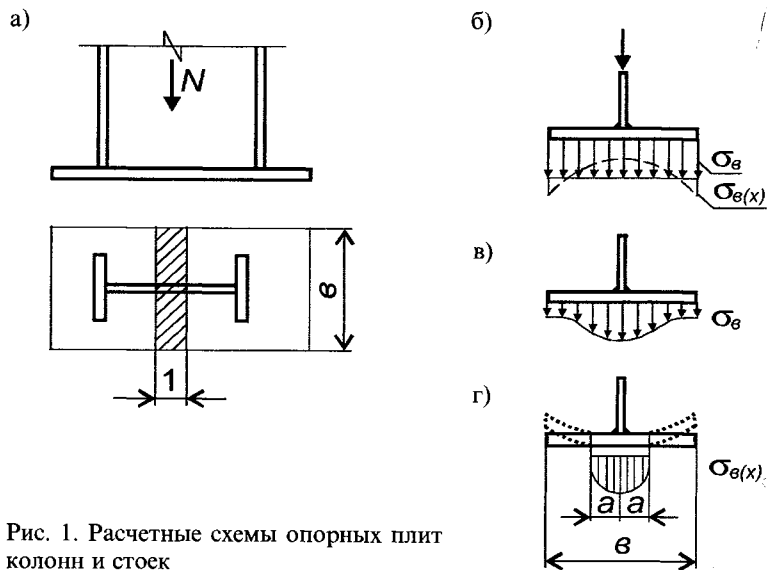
Расчетные схемы опорных плит колонн и стоек
